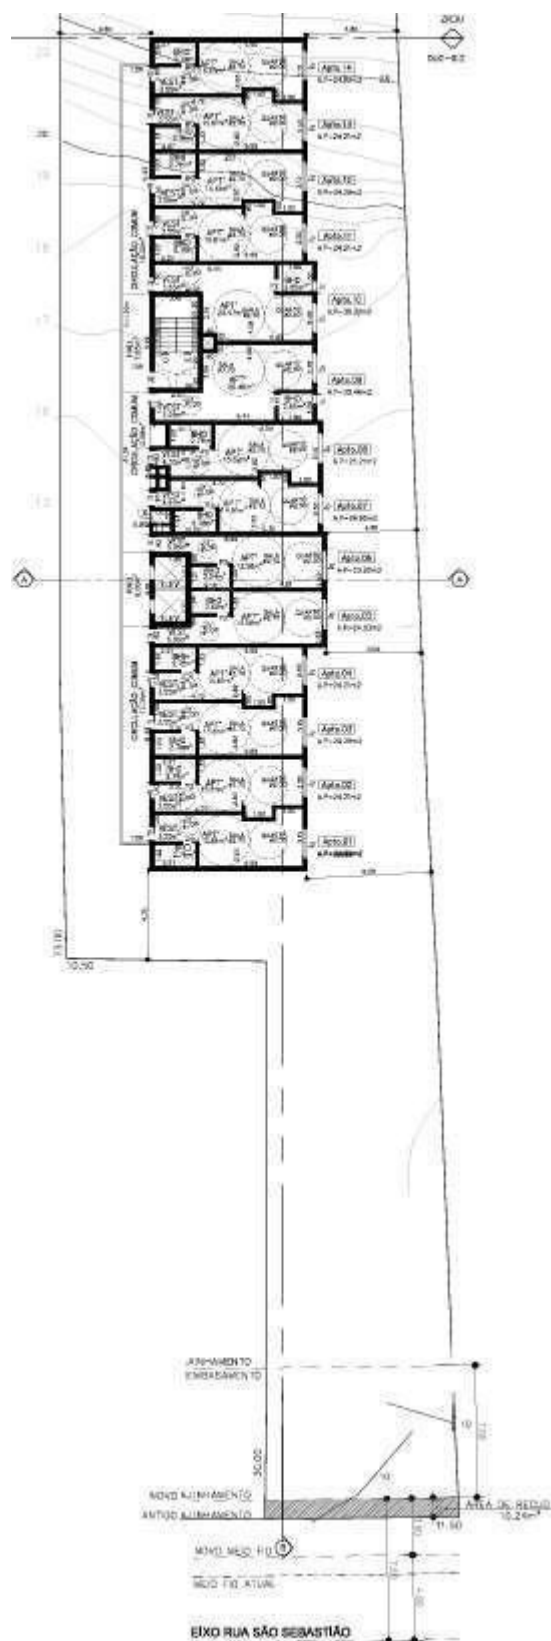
Pavimento Tipo (4º ao 17º) - Fonte: Projeto Legal
